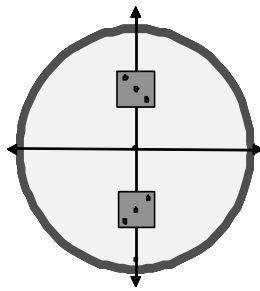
기초 설치 후 지반의 평면도 및 단면도
